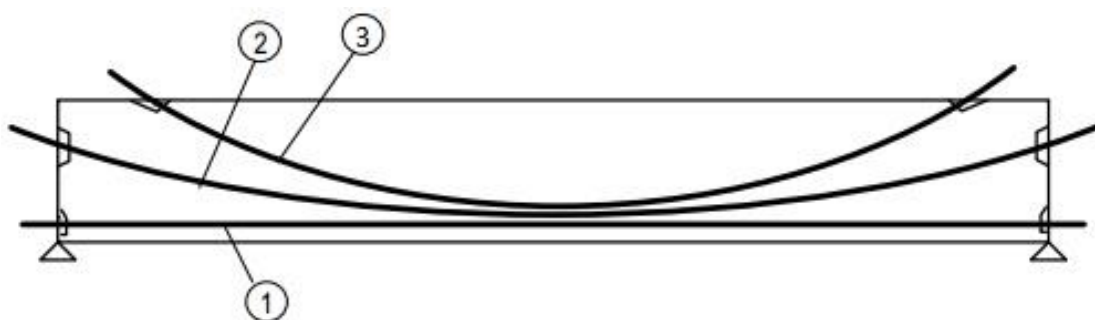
Exemplos de distribuição de armadura pré-tracionada em vigas
